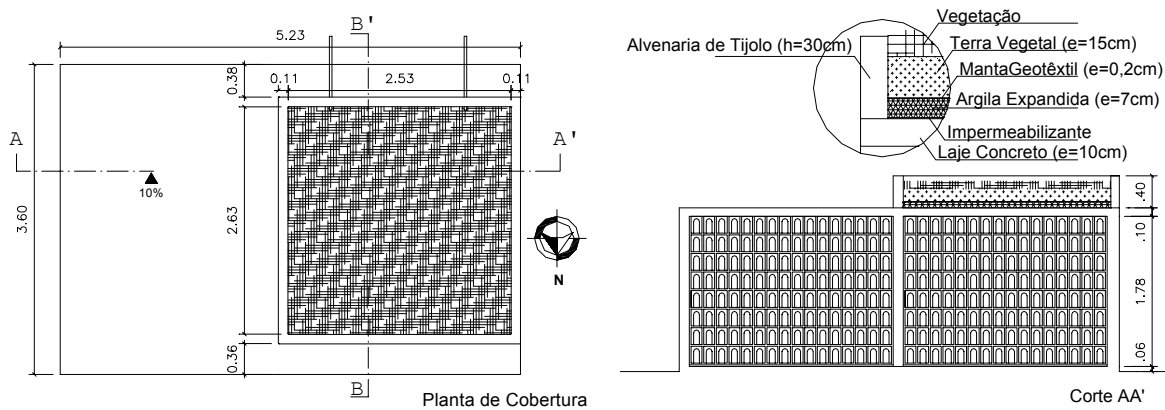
Planta e corte esquemáticos da cobertura do protótipo
